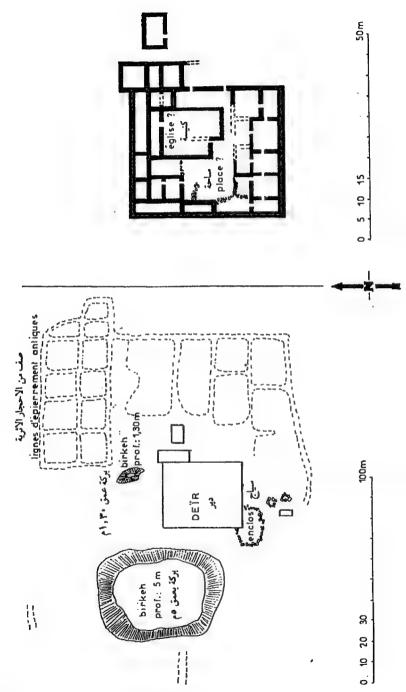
Deir ash-Sha'fr : plan de situation et plan du deir. الشكل رتم ۲۲ مدير الشمير غطط الموقع وغطط المدير
